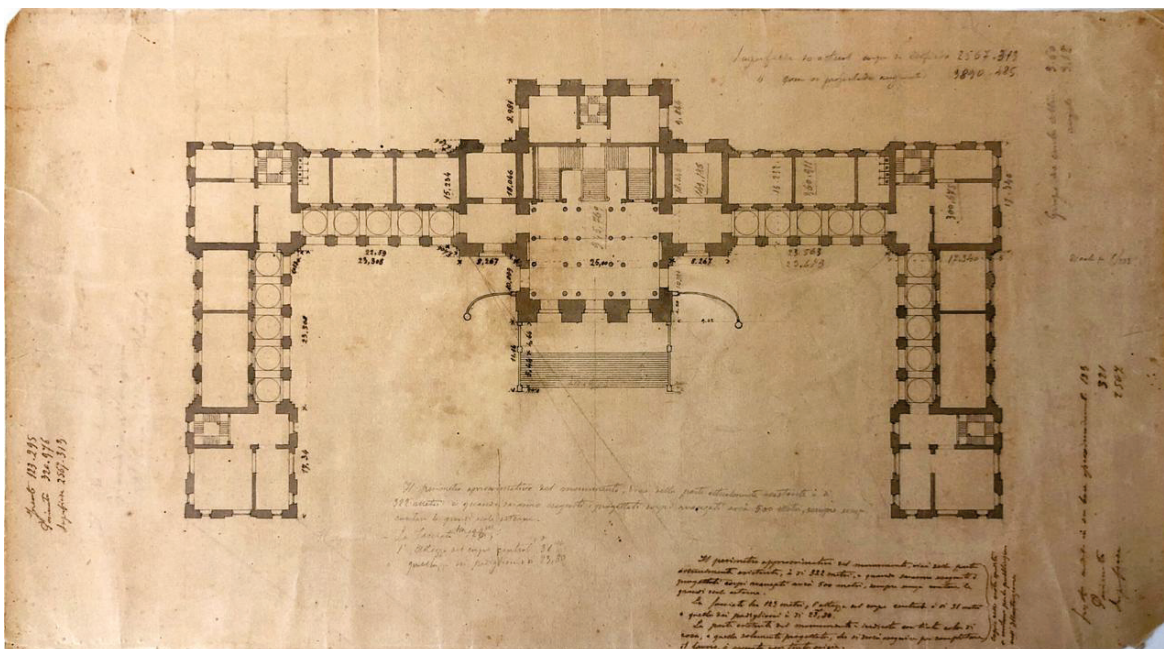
Planta do pavimento térreo do edifício-monumento. Na parte inferior, lê-se “A fachada tem 123 metros, a altura do corpo central é de 31 metros e a das galerias é de 23.80”.
